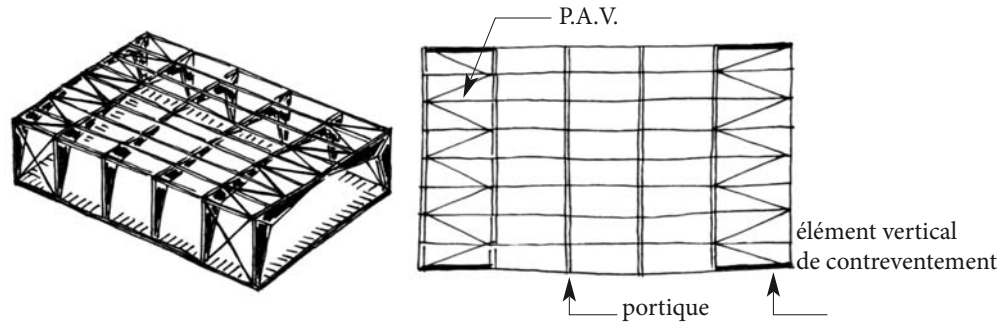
Contreventement d'une structure à portiques transversaux
